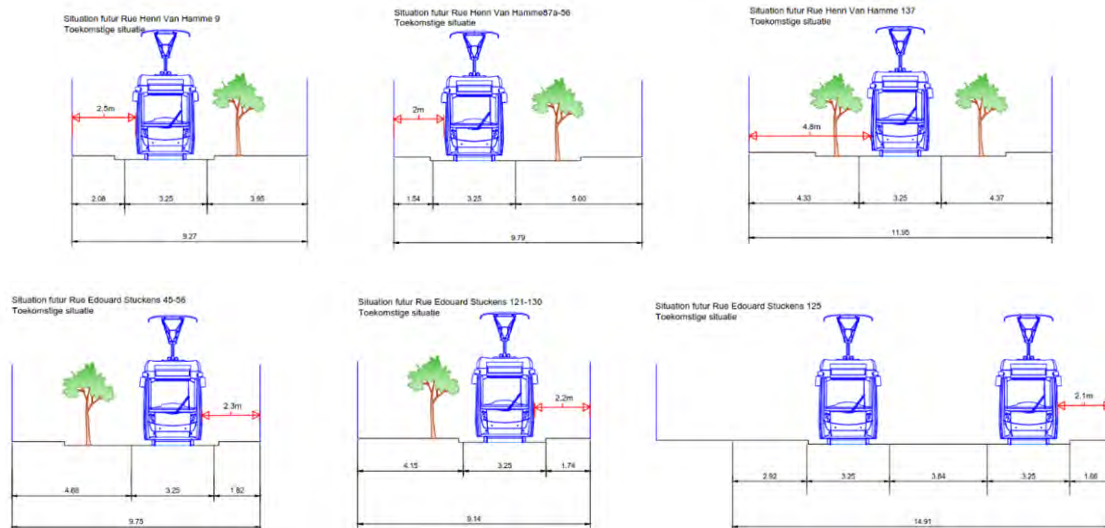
Distances entre les trams et les façades Tractebel 2020 sur base de plan STIB, 2020
